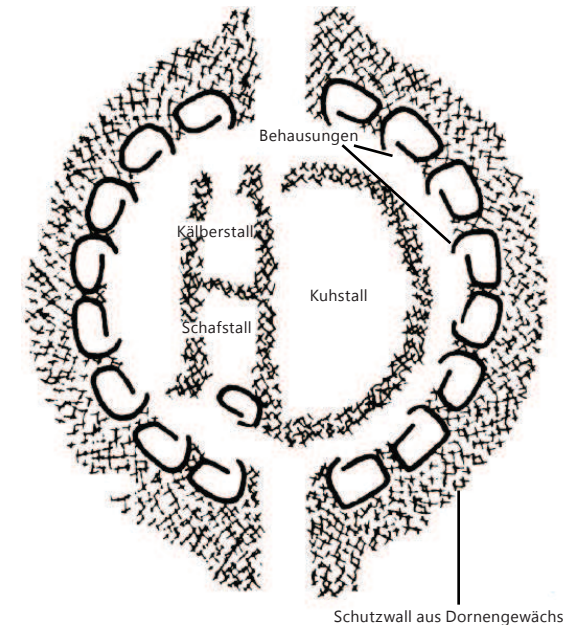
Grundriss einer Massaidorfgemeinschaft; die Hütten sind kreisförmig angeordnet, im Inneren des Kreises befindet sich ein Zaun aus Dornengestrüpp, in dem das Vieh bei Nacht untergebracht wird; als zusätzliche Barriere gegen Raubtiere bildet ein Ring aus Dornengestrüpp einen Schutzwall um das gesamte Dorf
